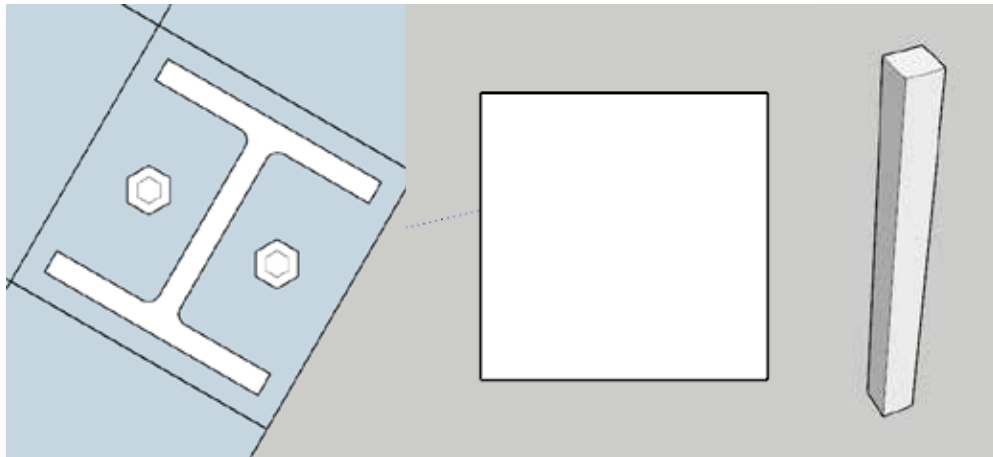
Secciones de columnas usados en el proyecto. (2019)
